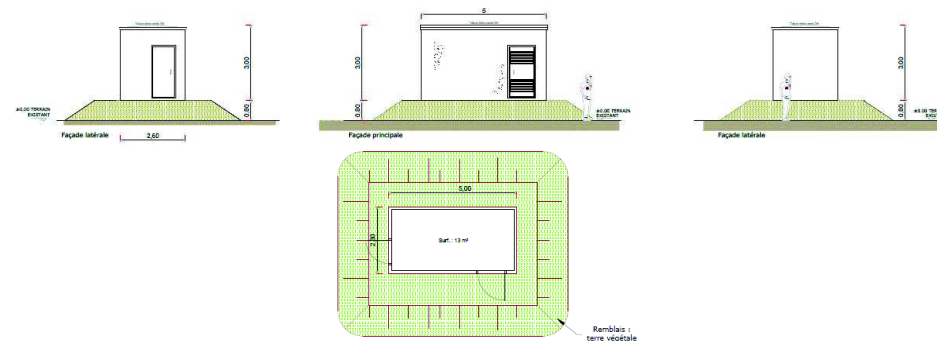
Vues des façades d'un poste transformateur prévu sur site
